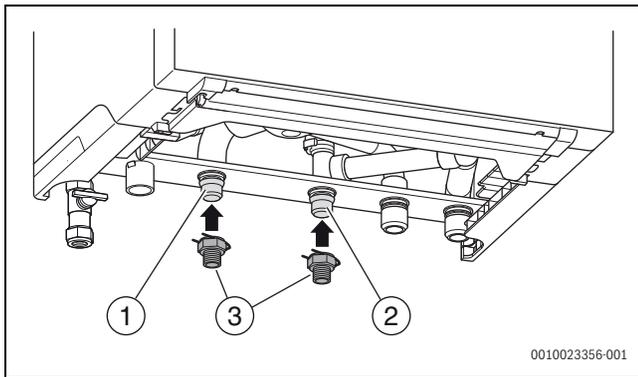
Rohrleitungen für externen Warmwasserspeicher montieren
